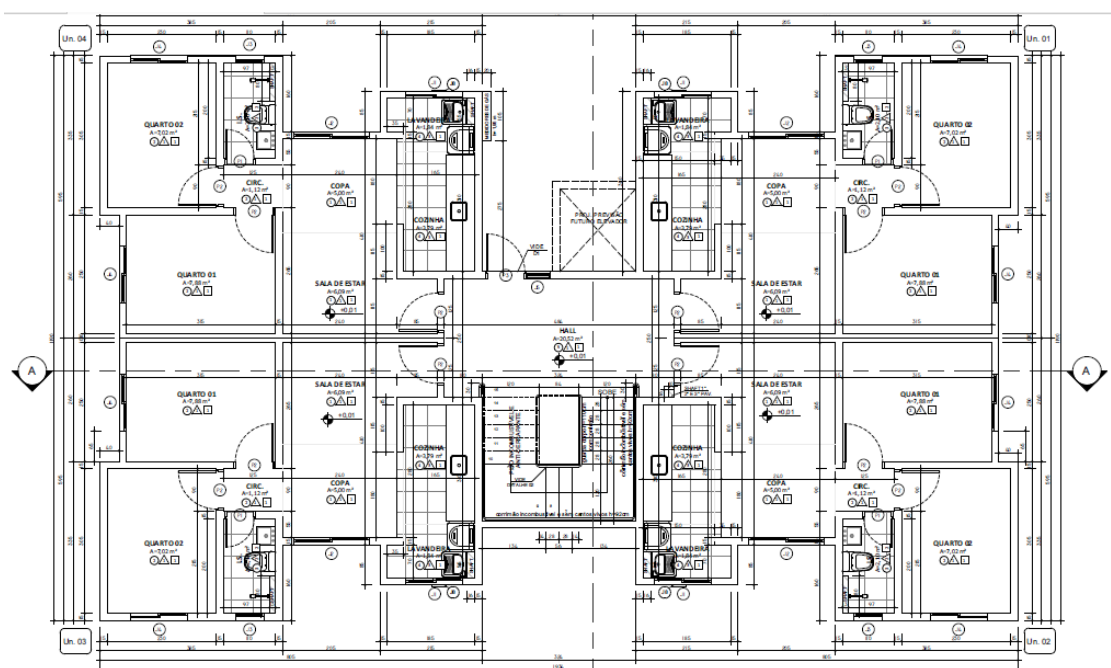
Planta Tipo (Obra Maranello Residencial Club) Fonte: O autor, 2017
